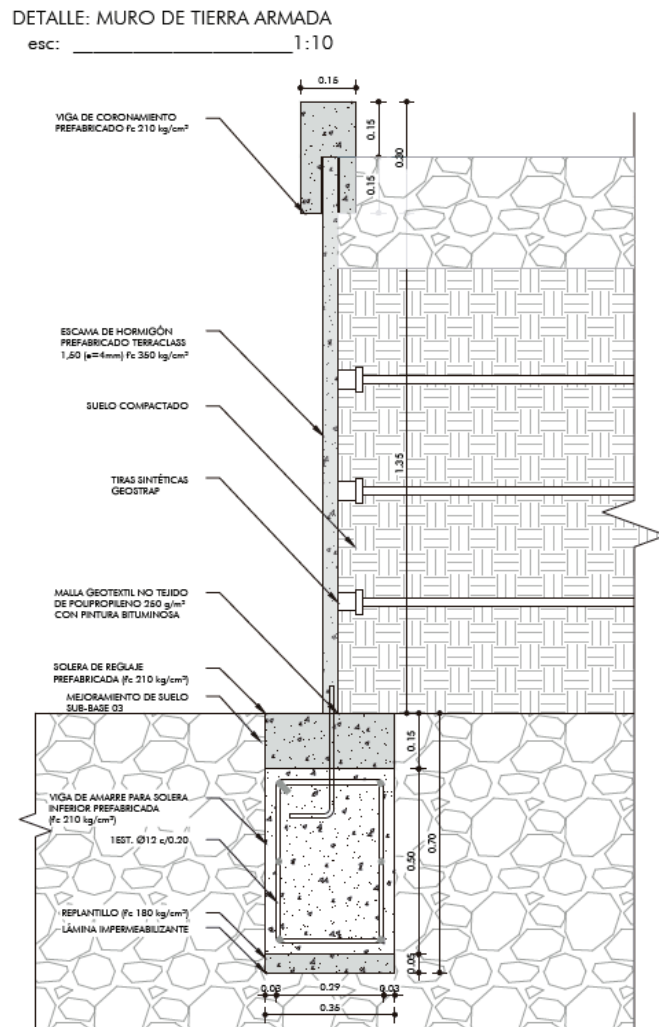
Detalle de muro de tierra armada. (Elaborado por: Jaire Cagigal)
